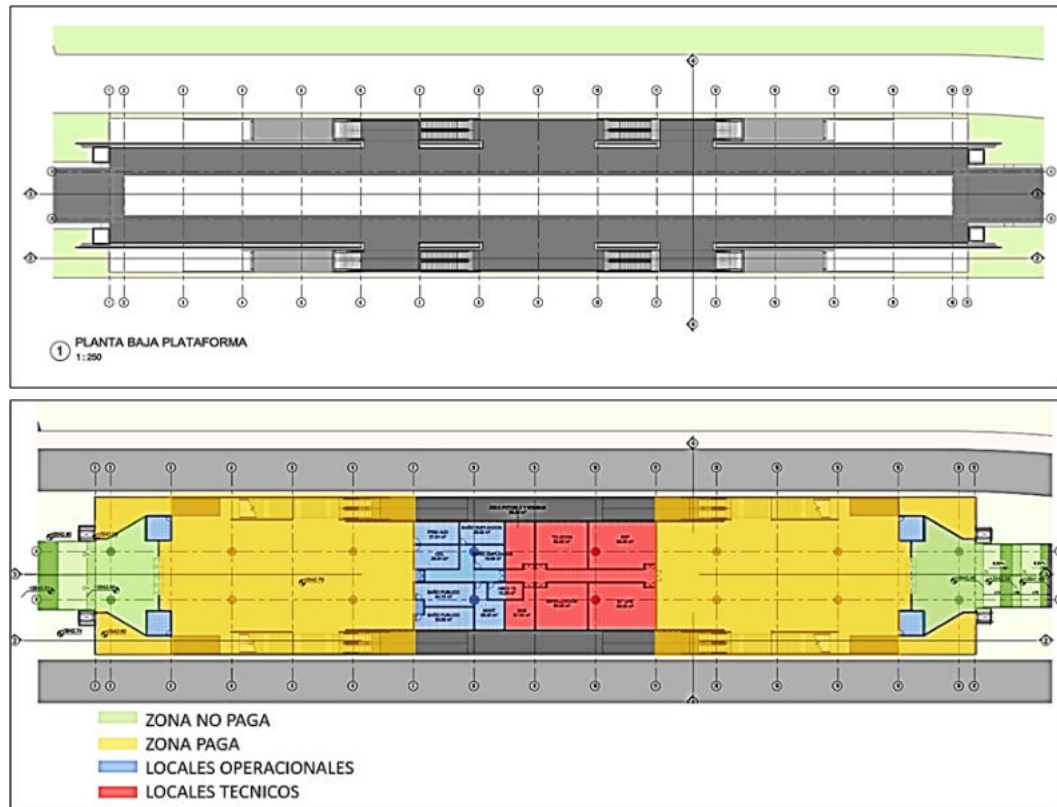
Planta baja plataforma y planta vestíbulo estación elevada E11
